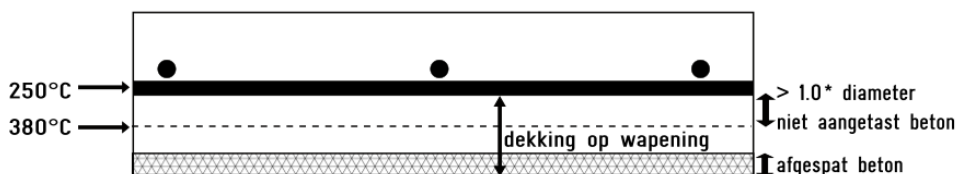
Schematische voorstelling eisen aan brandwerendheid aan het plafond van onderwatertunnels
